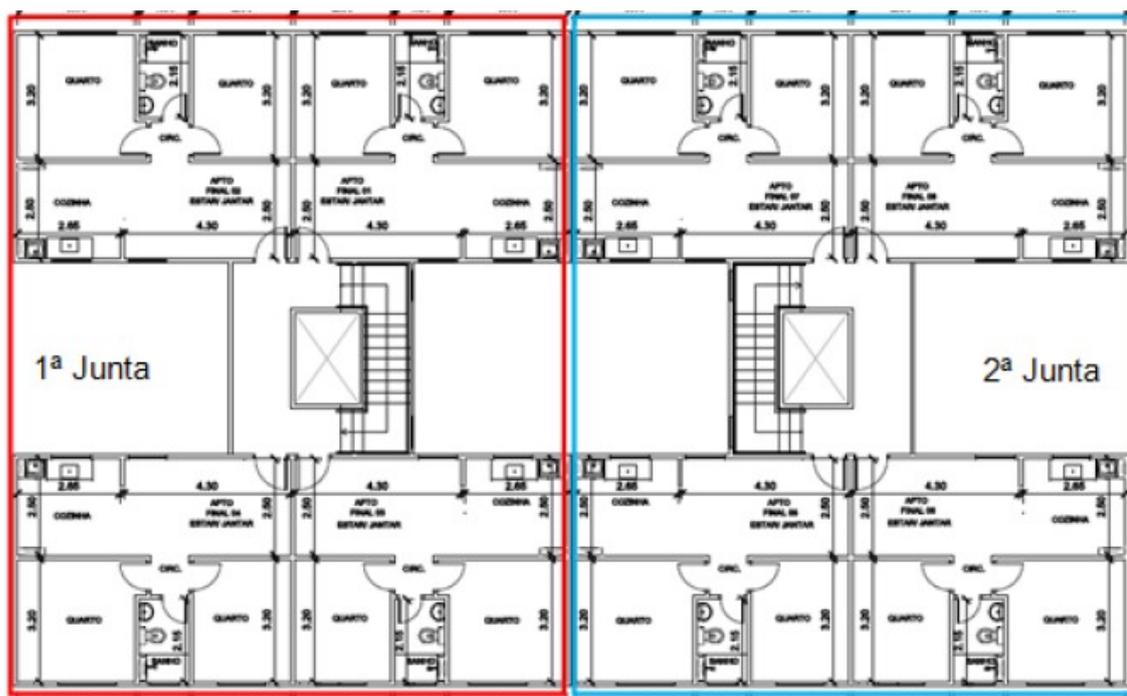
Divisão do pavimento para montagem das fôrmas e concretagem
